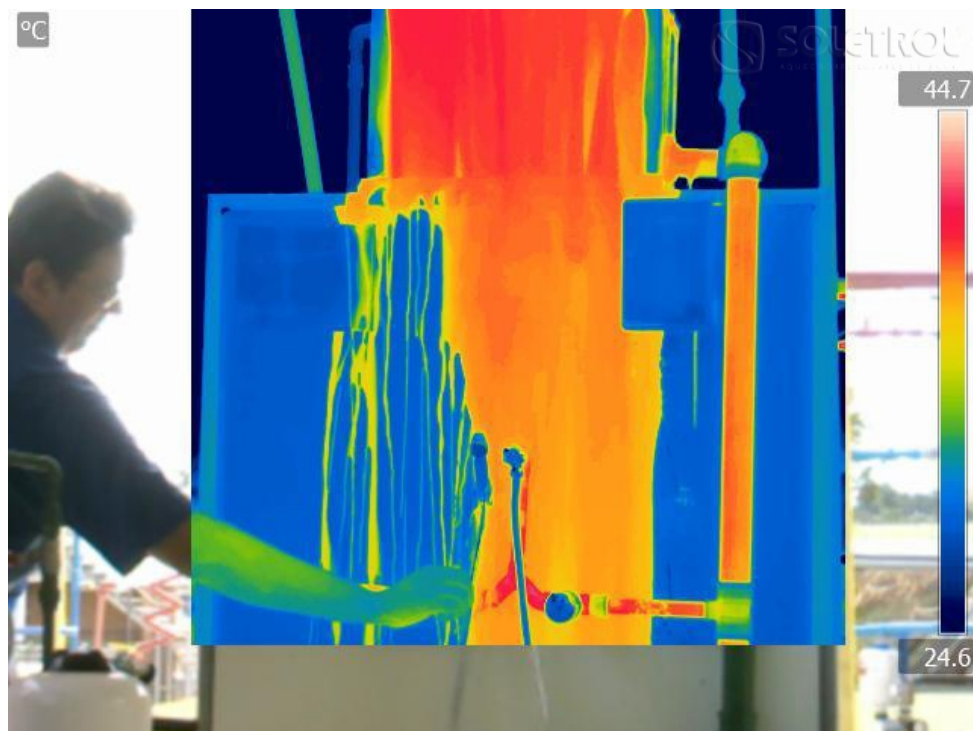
imagem infravermelha de válvula de descarga instalada equivocadamente
